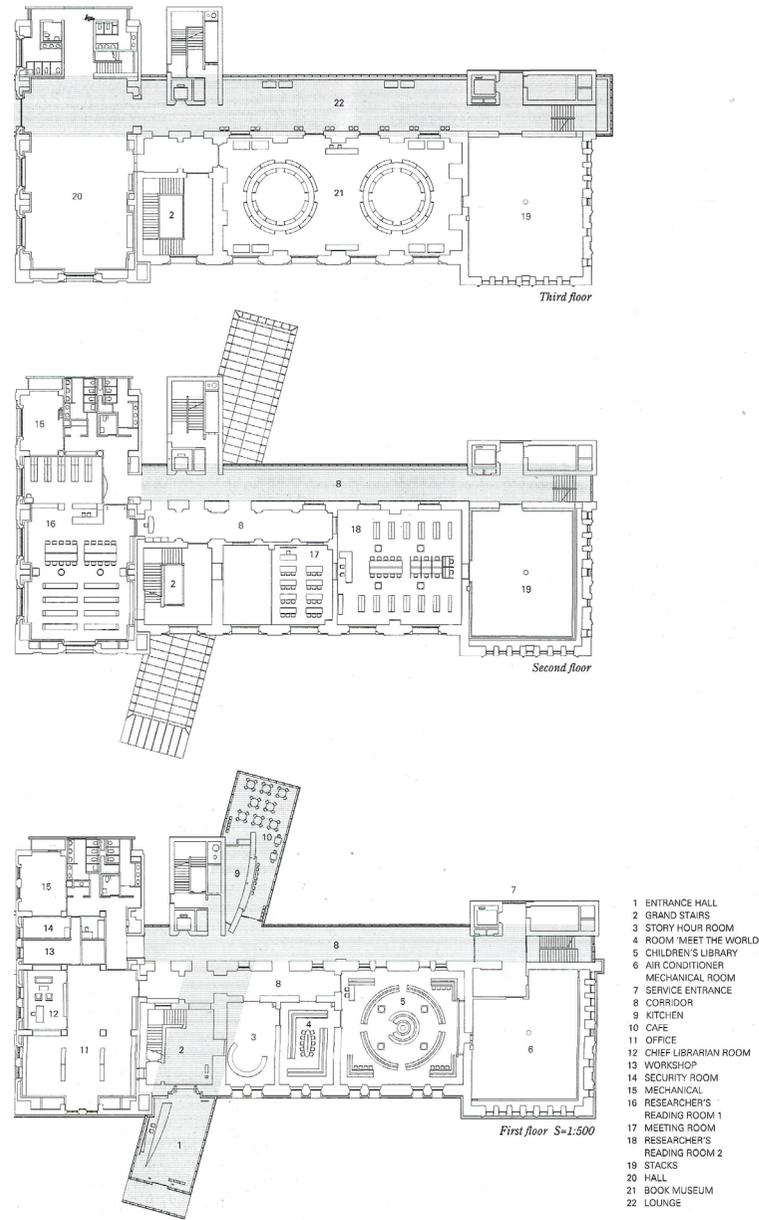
Plantas baja, primera y segunda (de bajo hacia arriba) de la Biblioteca de Literatura Infantil.
